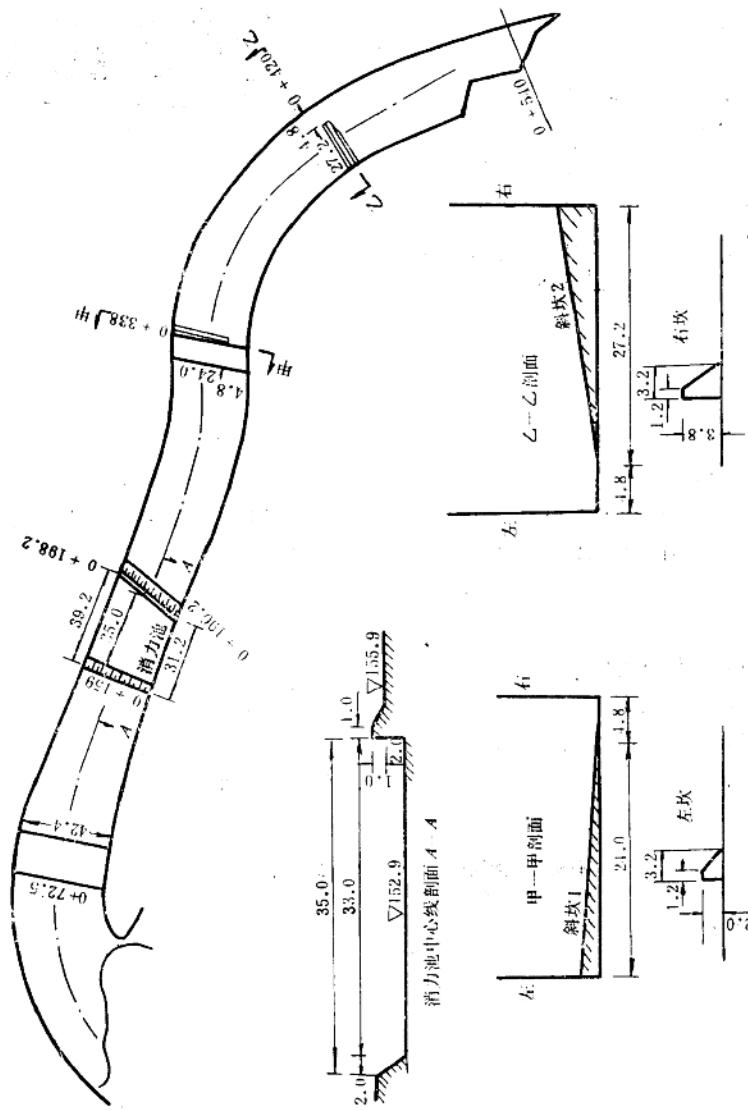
南谷洞陡槽溢洪道平面图(单位: m)
